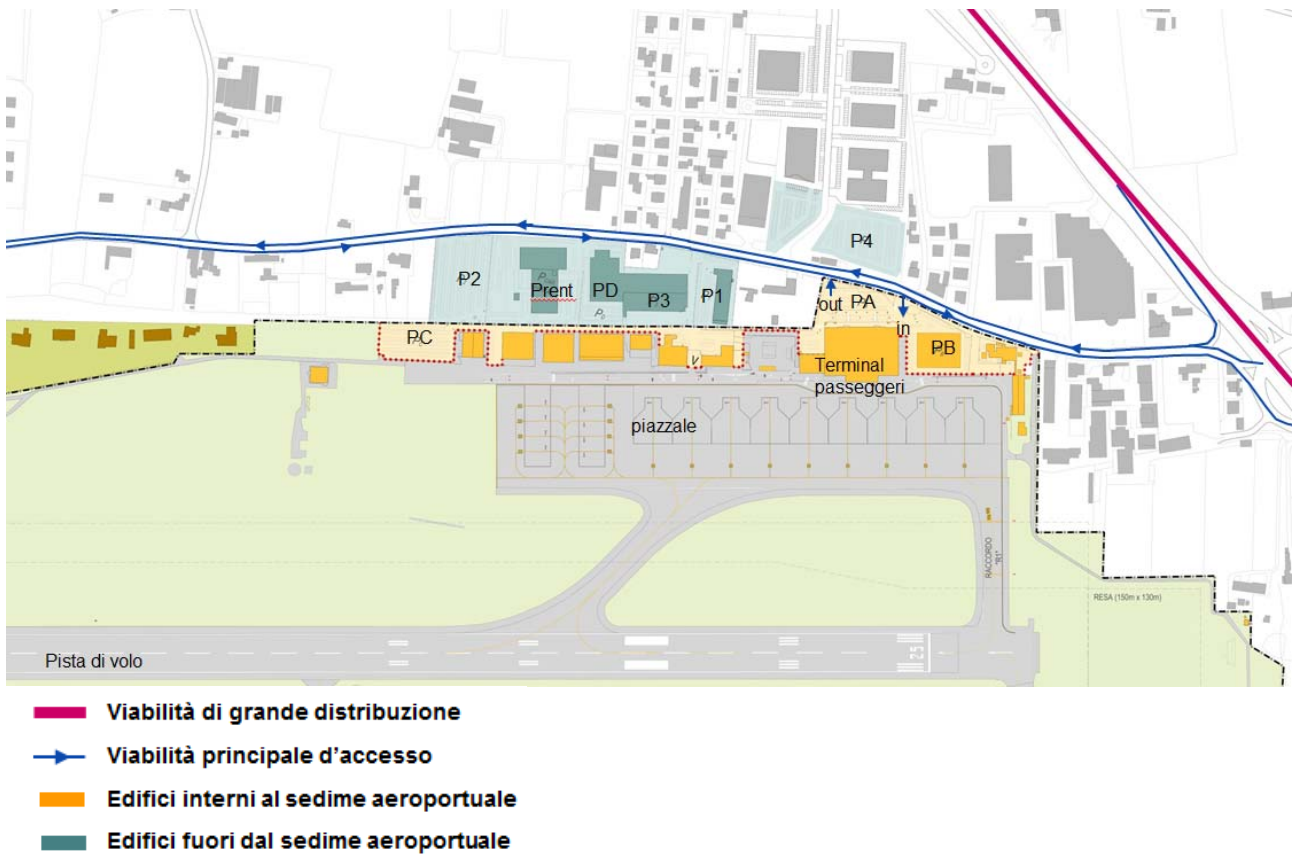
Planimetria generale dello stato di fatto – schema di accessibilità land side e sistema dei parcheggi
